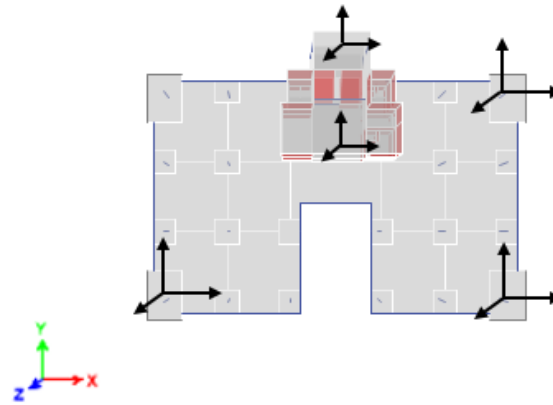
Esquema de ubicación de sensores en la Octava planta y terraza de la estructura.
